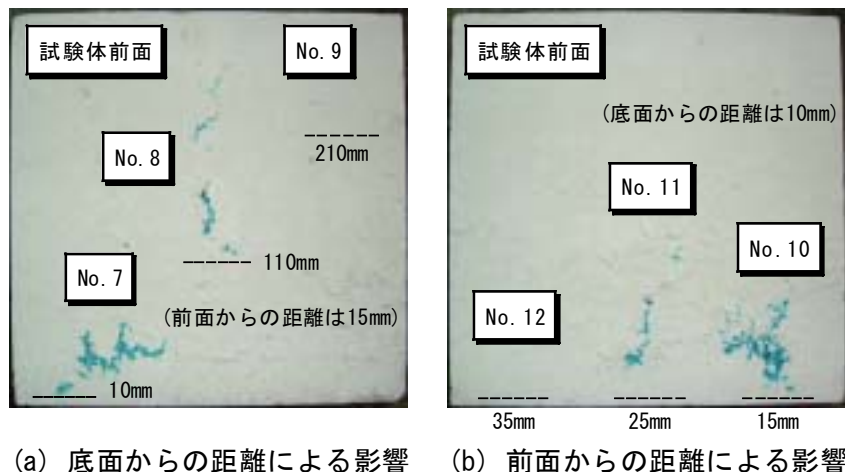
試験体前面の着色状態に及ぼす着色液注入位置の影響 (スランプ18cm)
